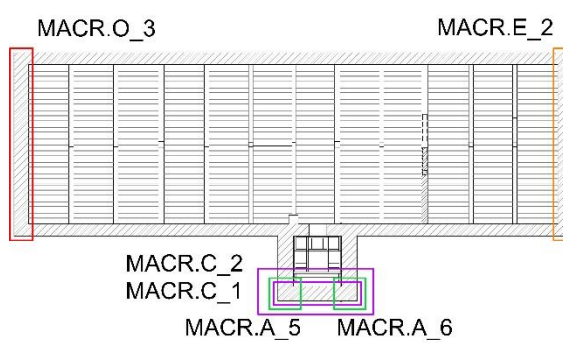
Individuazione nella pianta delle coperture dei macroelementi.
